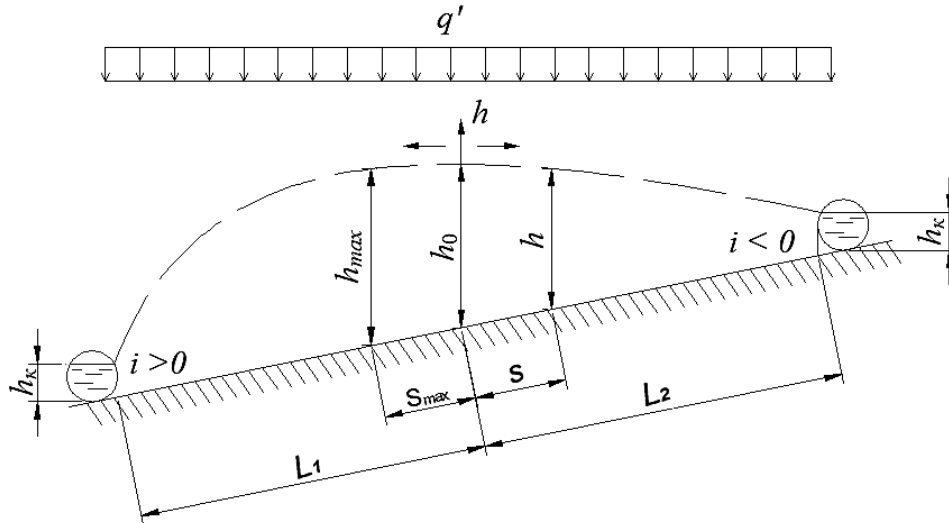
Расчетная схема бесполостной дрены треугольного поперечного сечения
